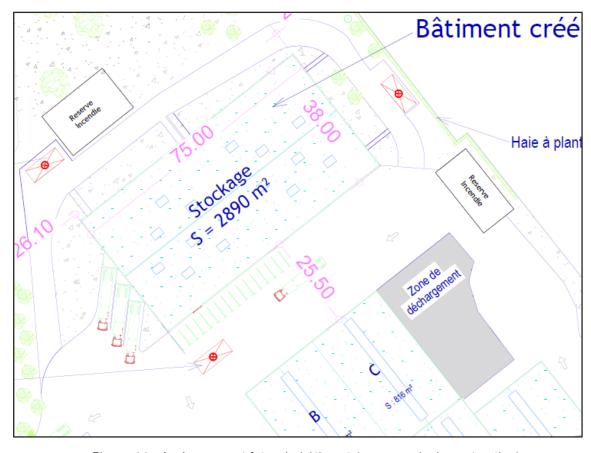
Aménagement futur de bâtiment (source : sicabconstruction)
